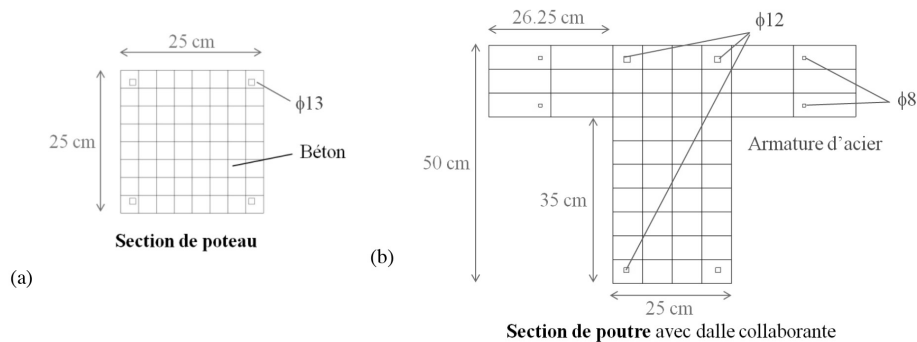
Sections de la structure poteaux-poutres : (a) pour les poteaux et (b) pour les poutres [TAT 11]
